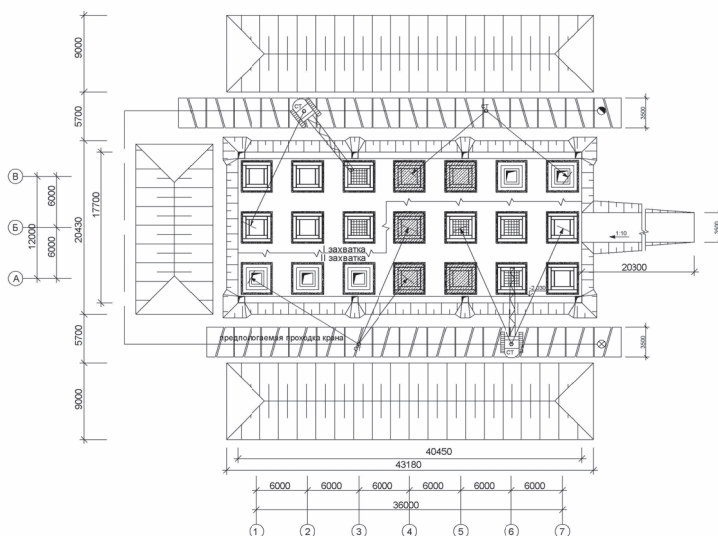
Схема производства работ при устройстве монолитных фундаментов
